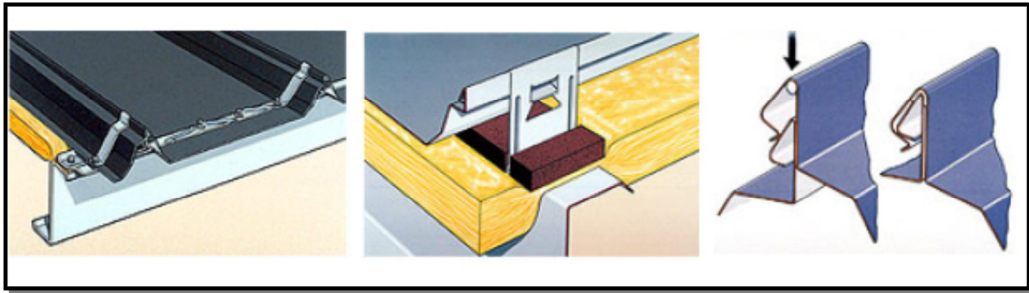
Roof System - TIPO 2: *Floating Roof
